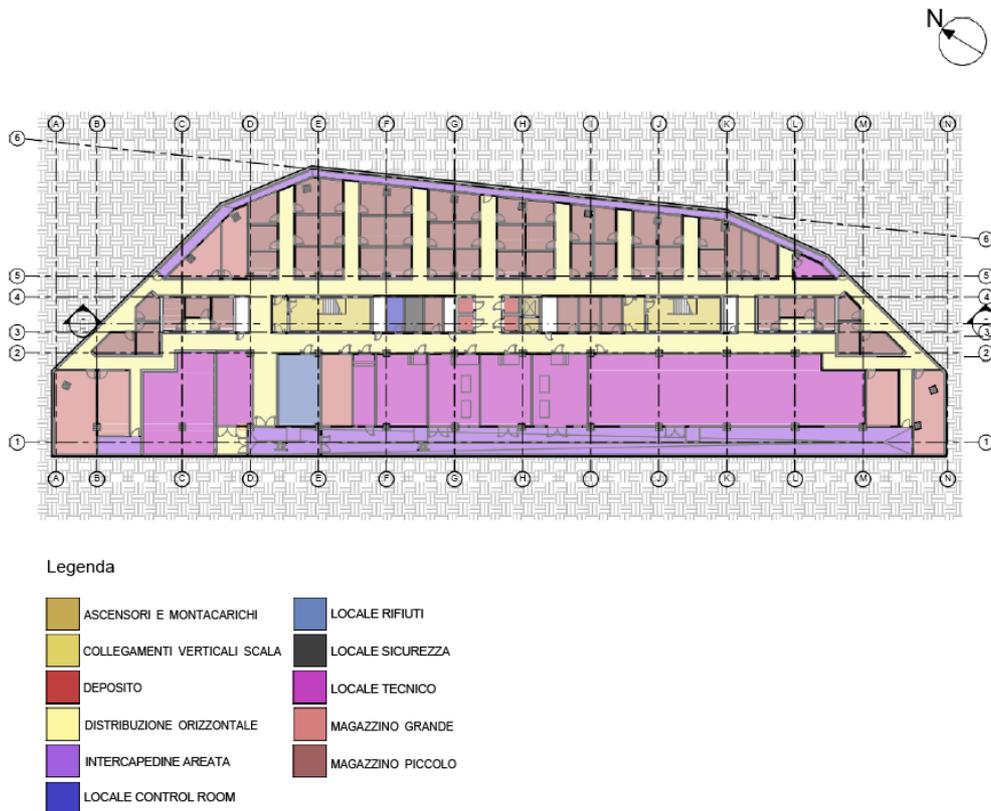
Pianta del piano interrato (aggiornare pianta piano interrato)
